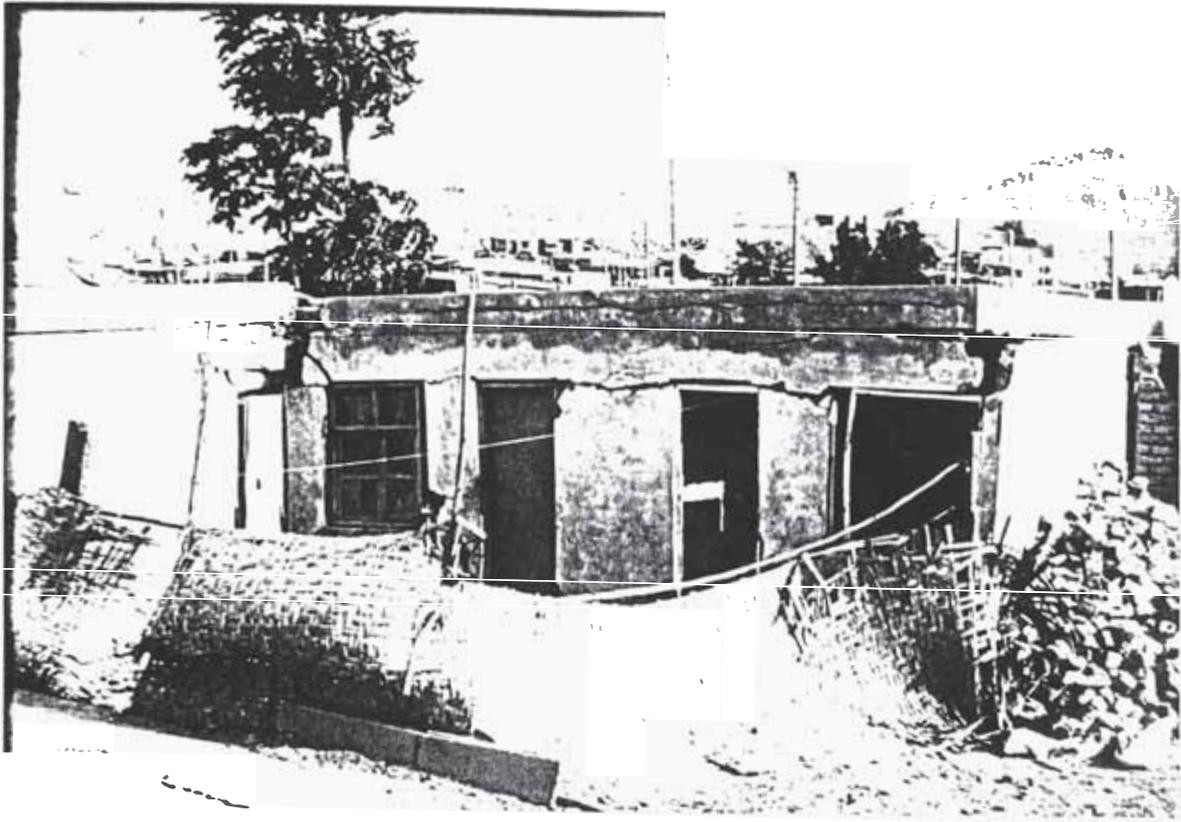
Casa completamente destruida por las acción de las arcillas expansivas.
